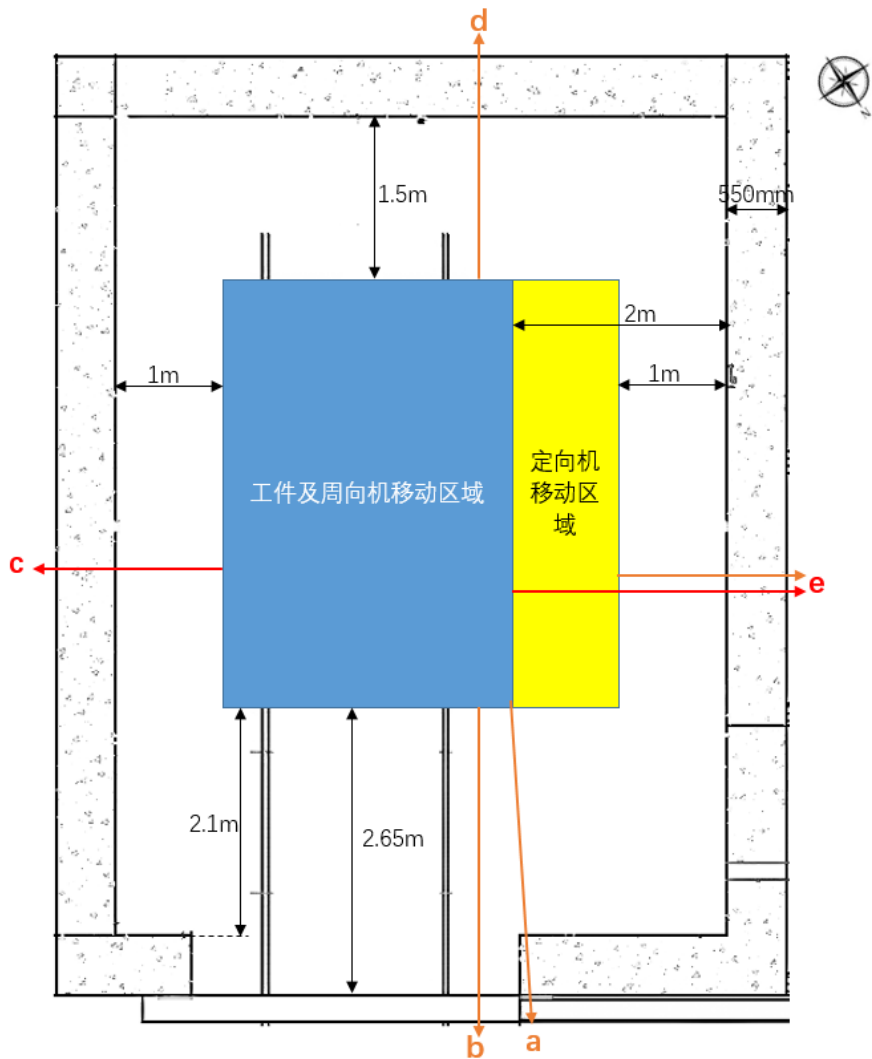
辐射屏蔽计算预测点位平面图 (单位: mm)
